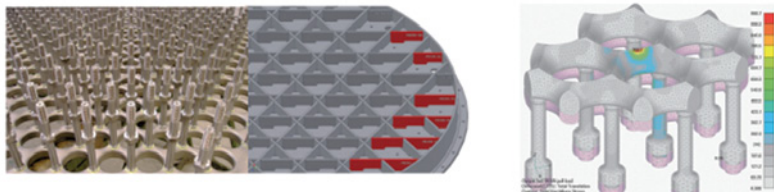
Конструктивные элементы палубной решетки с эторой нагрузок из каталога компании Cramm HLS
